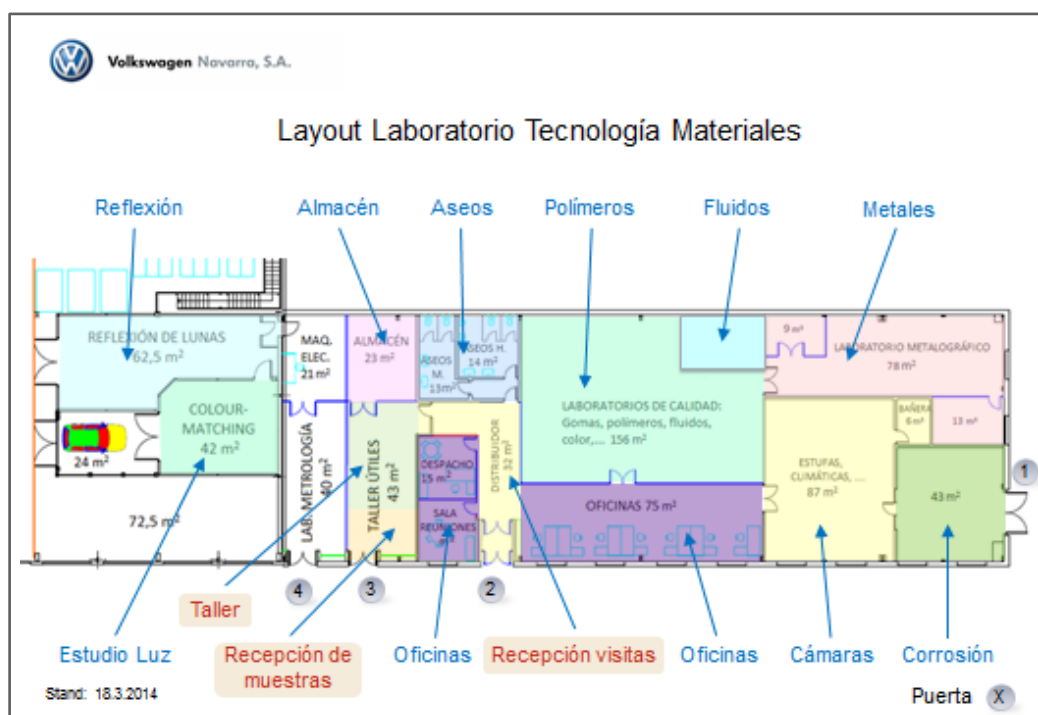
Layout Tecnología de Materiales tras reestructuración. Imagen disponible en ^[15]
